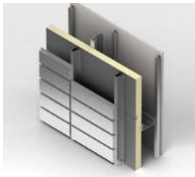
Painéis metálicos com estrutura em favo [22]
